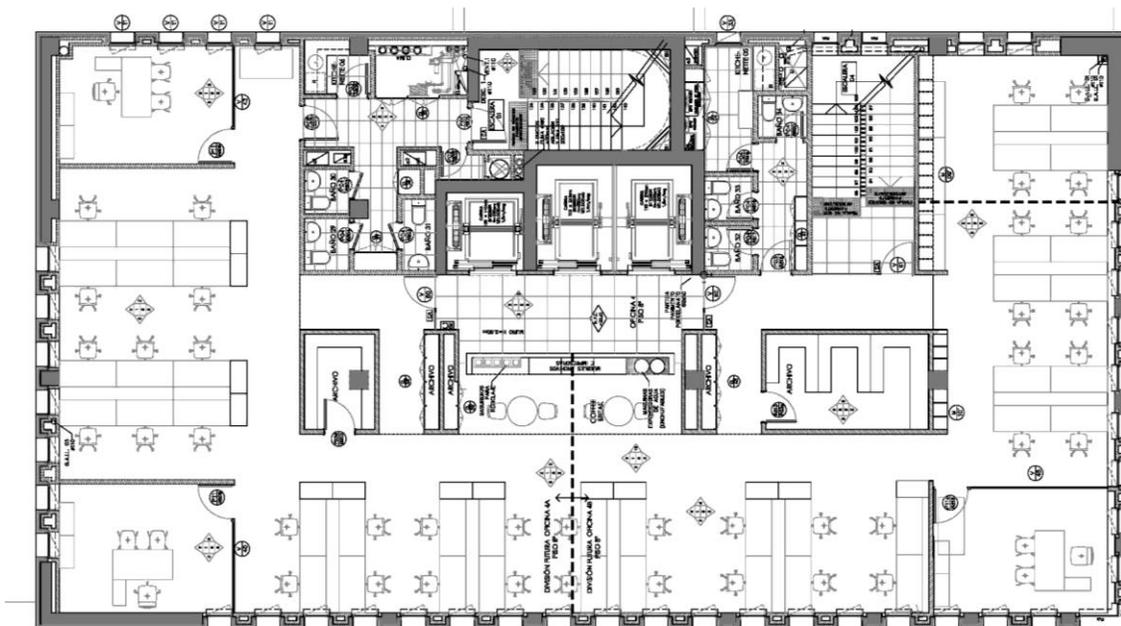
Planta pisos 6° al 8° edificio Caja Los Andes Viña del Mar- áreas de oficina planta libre
